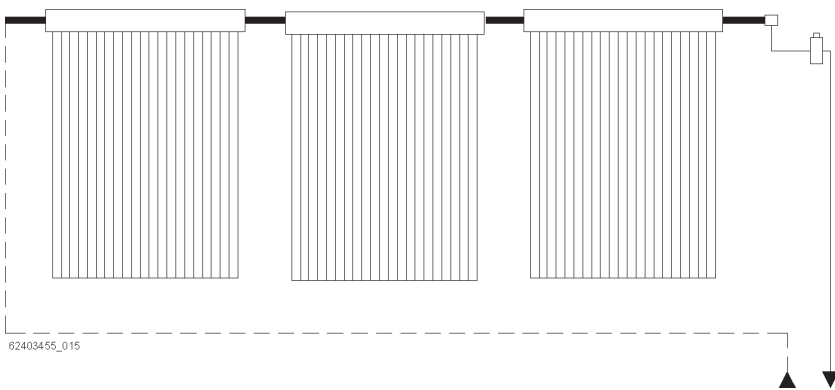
Collegamento in serie di pannelli HEATPIPE
